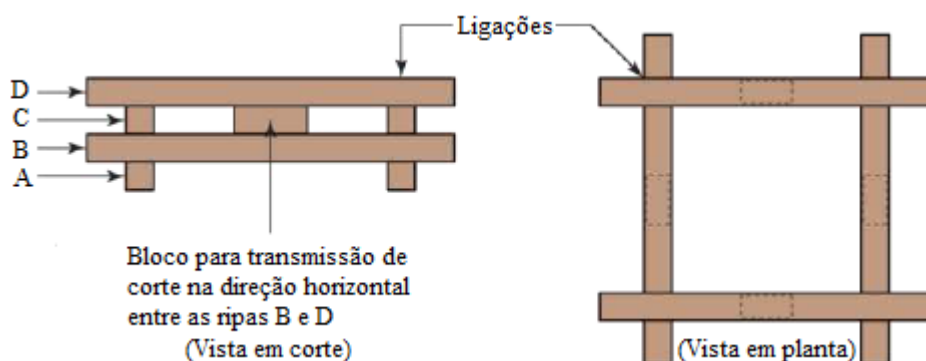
Vista em corte e em planta do sistema de camada dupla, demonstrando os blocos de transmissão de corte; Adaptado de Naicu et al (2014)
